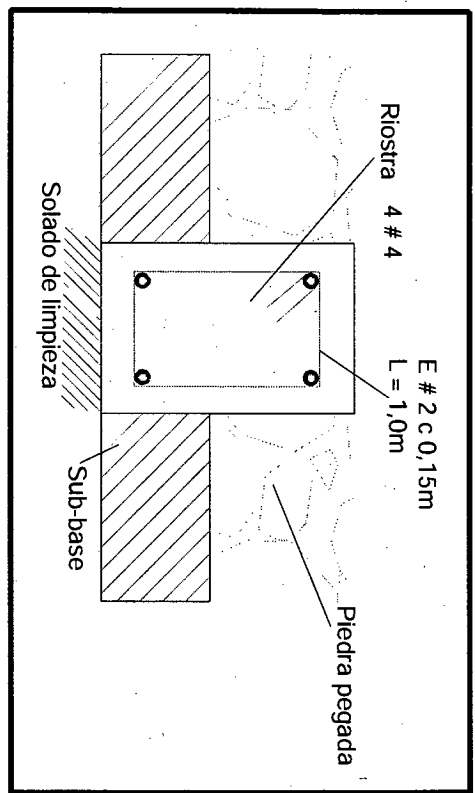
Corte Transversal Sección en Piedra Pegada
